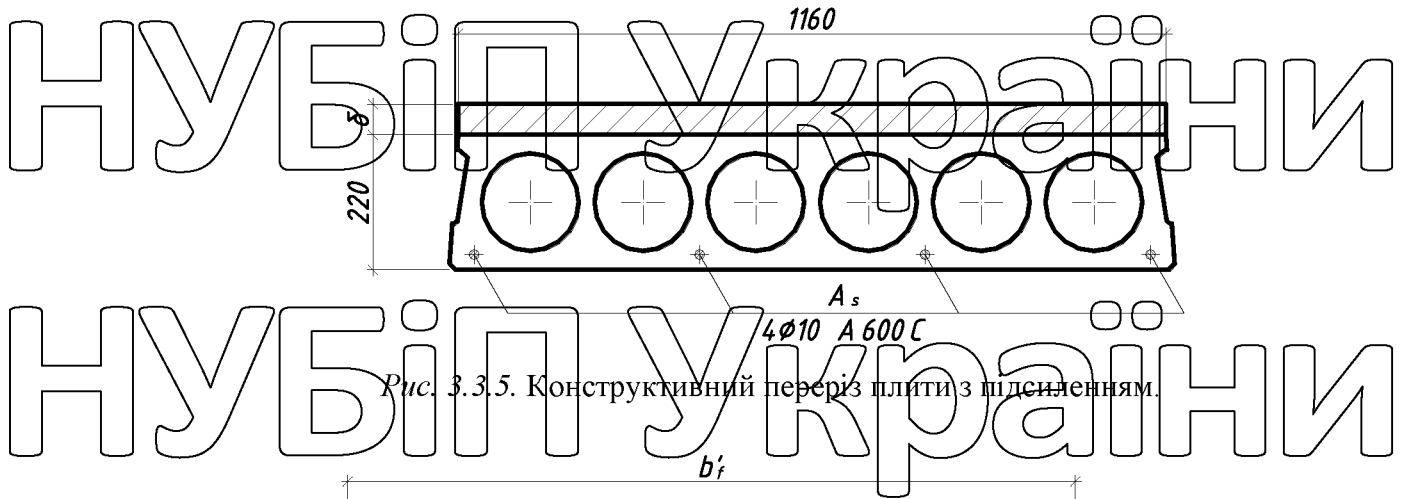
Конструктивний переріз плити з підсиленням.
